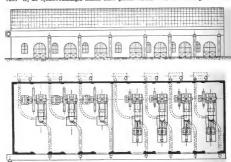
Elektrische Centrale und Gebläsemaschinen-Antage in Seraing 3500 P.S. 7 Simplex-Motoren von je 500 P.S.
